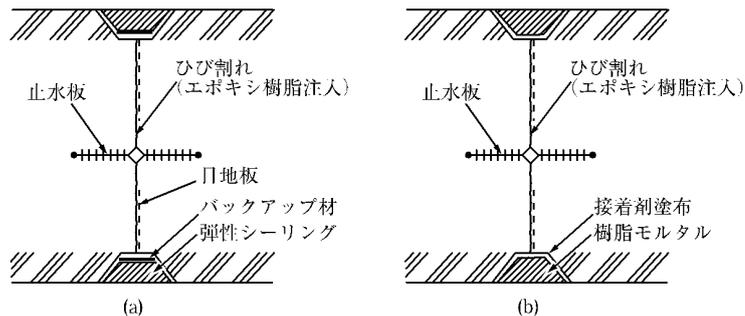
ひび割れ誘発目地部の処置方法 (参考)
